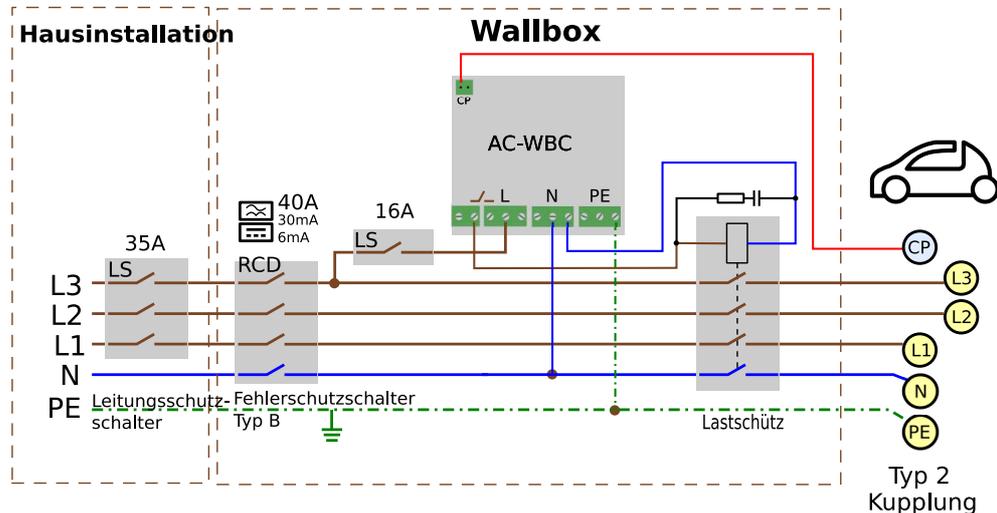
Dreiphasige Hausnetzeinbindung mit fest angeschlagenem Ladekabel
